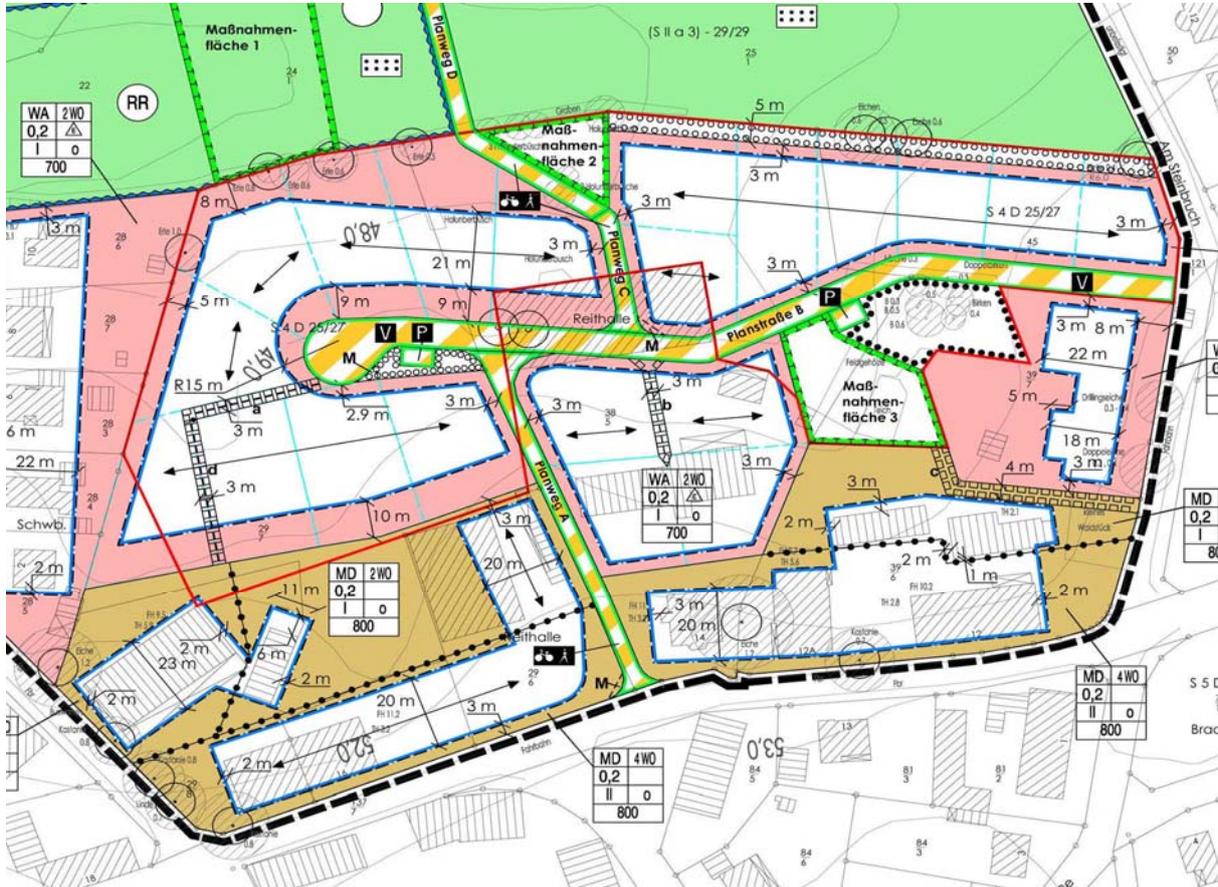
Ausschnitt B-Plan Nr. 16 „Altdorf“: Geltungsbereich 1
